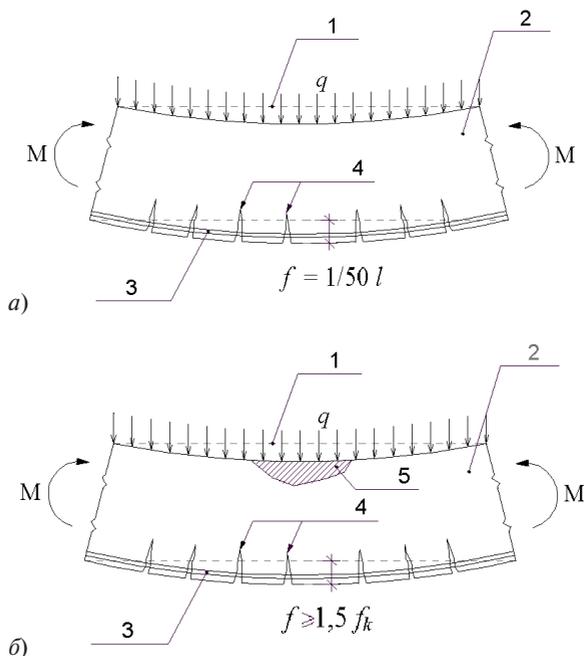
Характер разрушения конструкций: *a* – пластический характер разрушения; *б* – хрупкий характер разрушения от раздробления бетона сжатой зоны; 1 – состояние конструкции до приложения нагрузки; 2 – состояние конструкции после приложения нагрузки; 3 – рабочая арматура напряжения, в которой достигли предела текучести; 4 – трещины в растянутой зоне; 5 – раздробление бетона сжатой зоны
